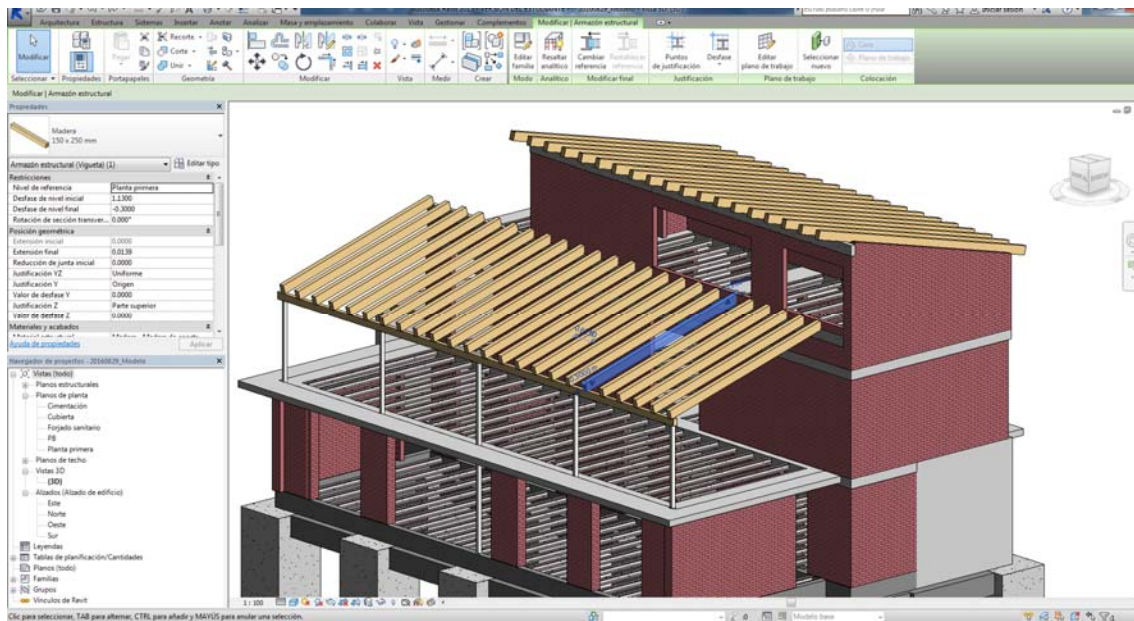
Empleo de propiedades de vigueta de cubierta para su modelado y ubicación. Fuente: Captura herramienta Revit.
